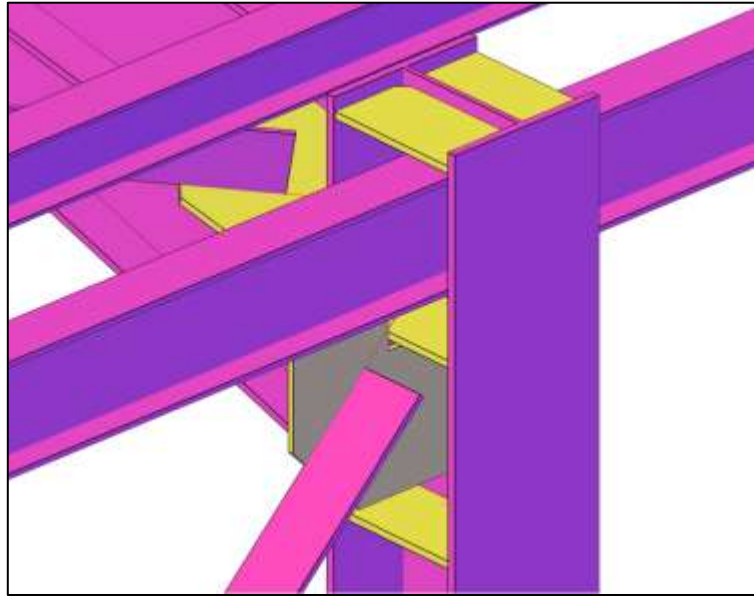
Conexión a corte Tranque – Columna (Perfiles: alma llena)
